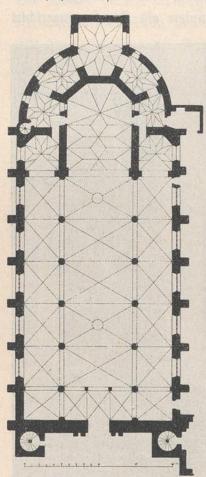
Luxemburg. Chemalige Jesuitenkirche. Grundriß.
